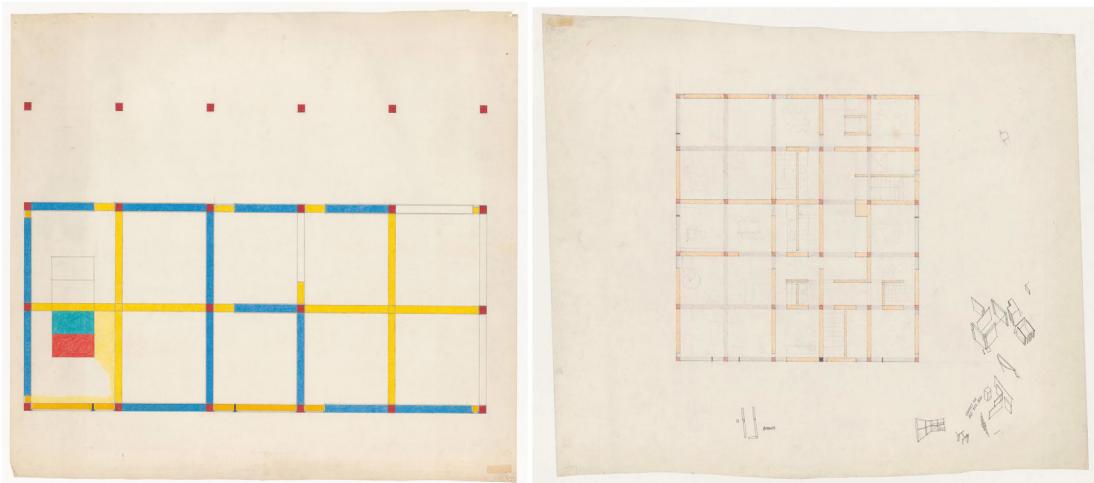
John Hejduk. Plan for Apartment House y Plan with Sketches for Apartment House, 1954-1963.
